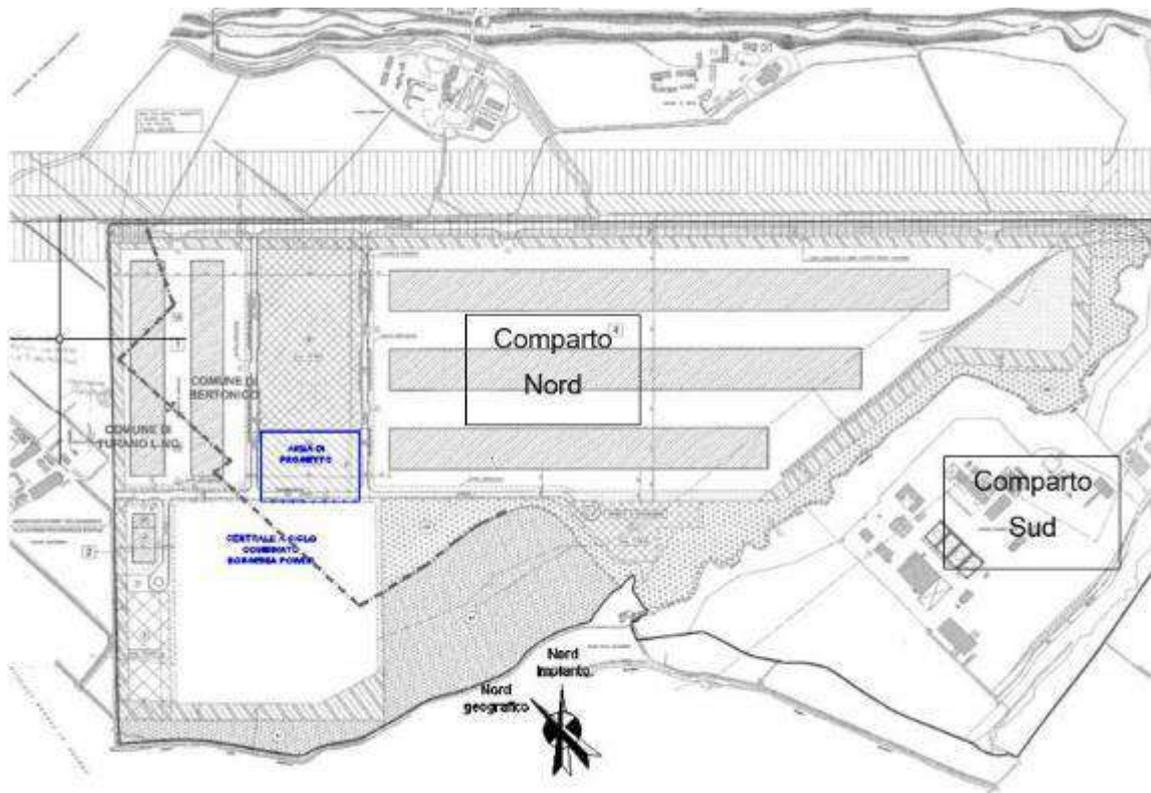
Localizzazione dell'impianto in progetto all'interno del Piano di Lottizzazione vigente all'epoca della realizzazione dell'esistente Centrale Sorgenia Power
